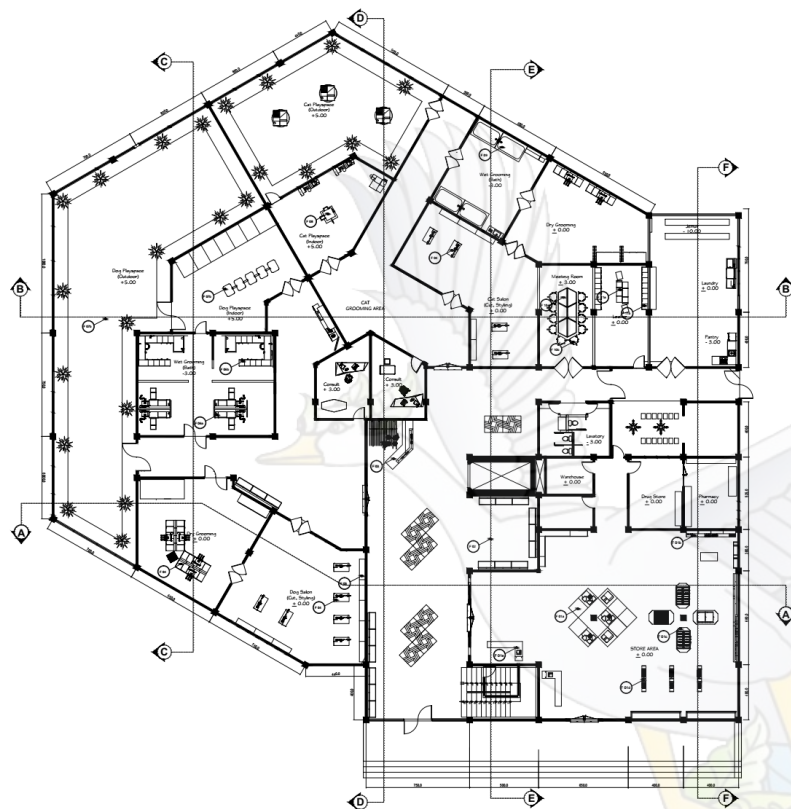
Alternatif I Rencana Layout Lantai 1
